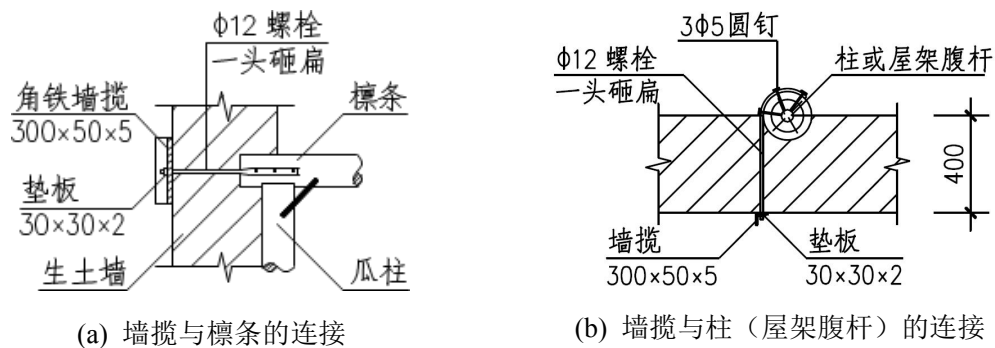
木墙揽连接做法 (单位: mm)
